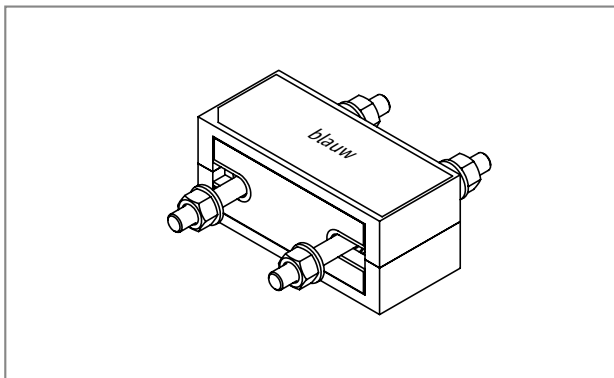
Schöck Isokorb® T type S-V-D22: Doorsnede
